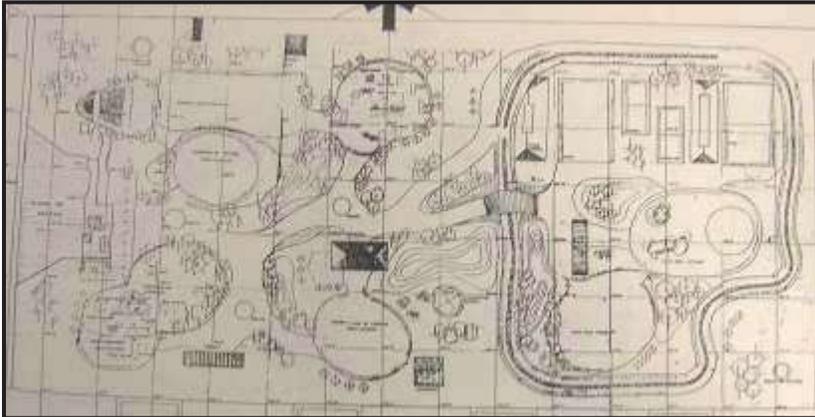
Plano arquitectónico de conjunto del parque 150.
